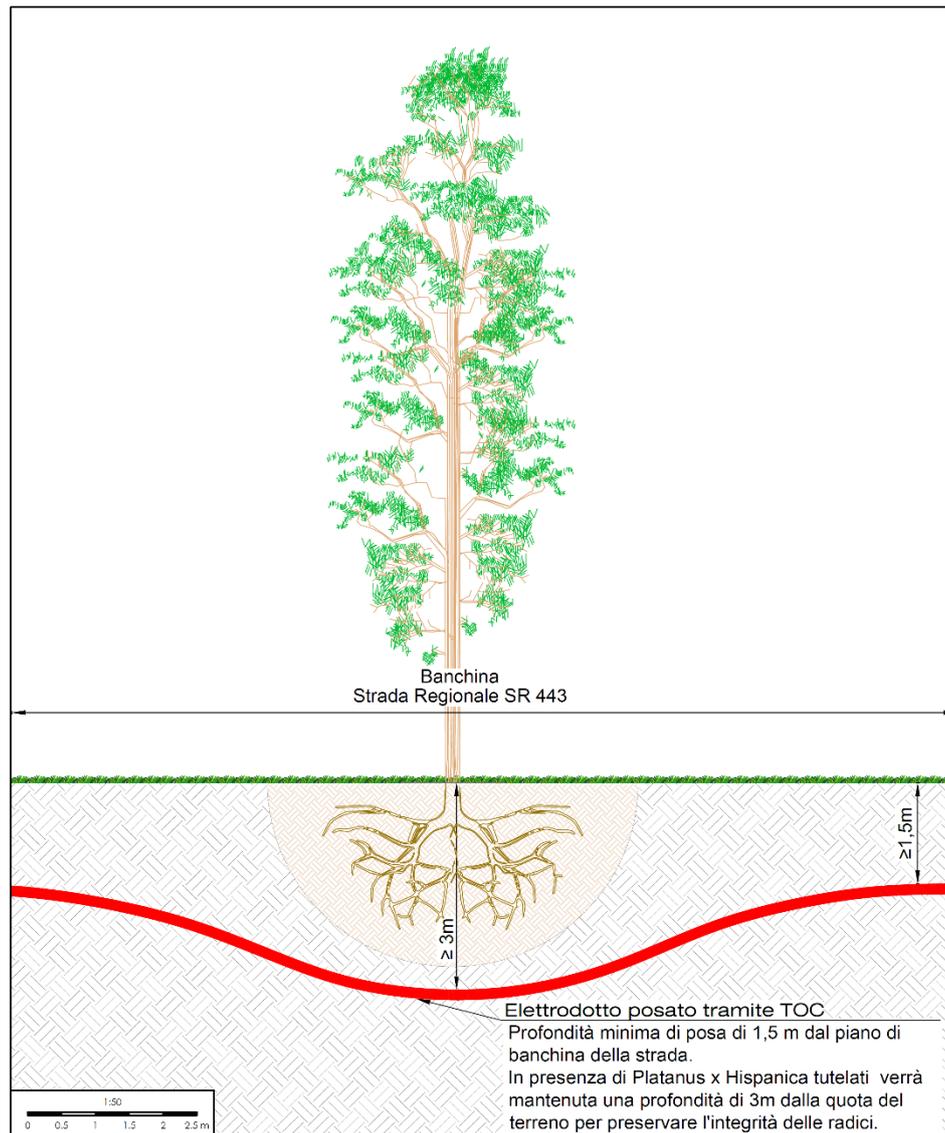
sezione longitudinale con visibile il rapporto fra la nuova condotta e l'apparato radicale dei platani
